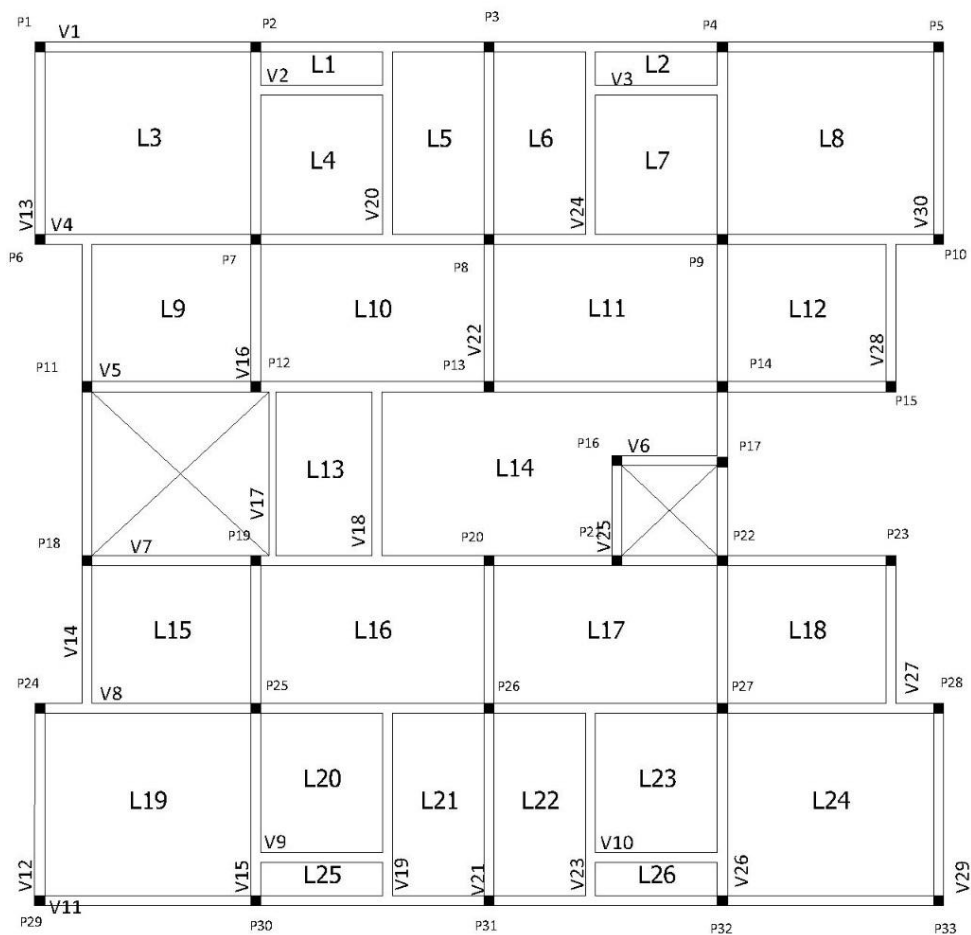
Localização das vigas e lajes da segunda concepção estrutural (Fonte: autor próprio)
